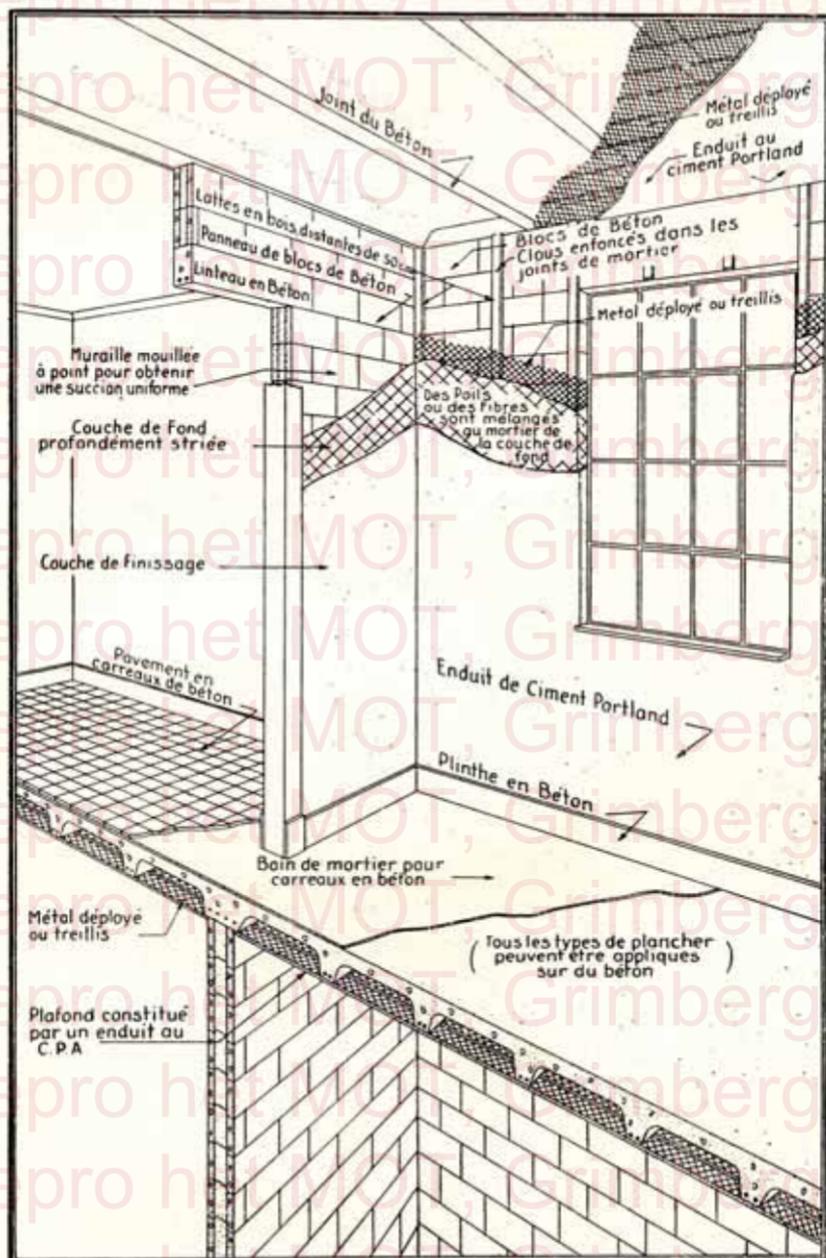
Hourdis, murs et cloisons avec enduits.
